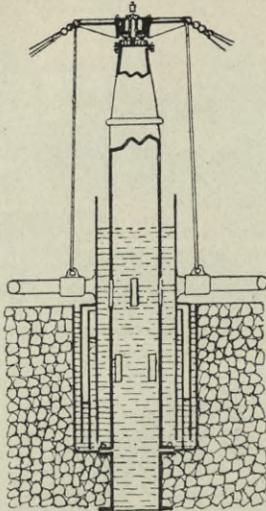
„Cresset“ Drehsprenger mit Wasserverschluß der Firma Adams, York und London.
